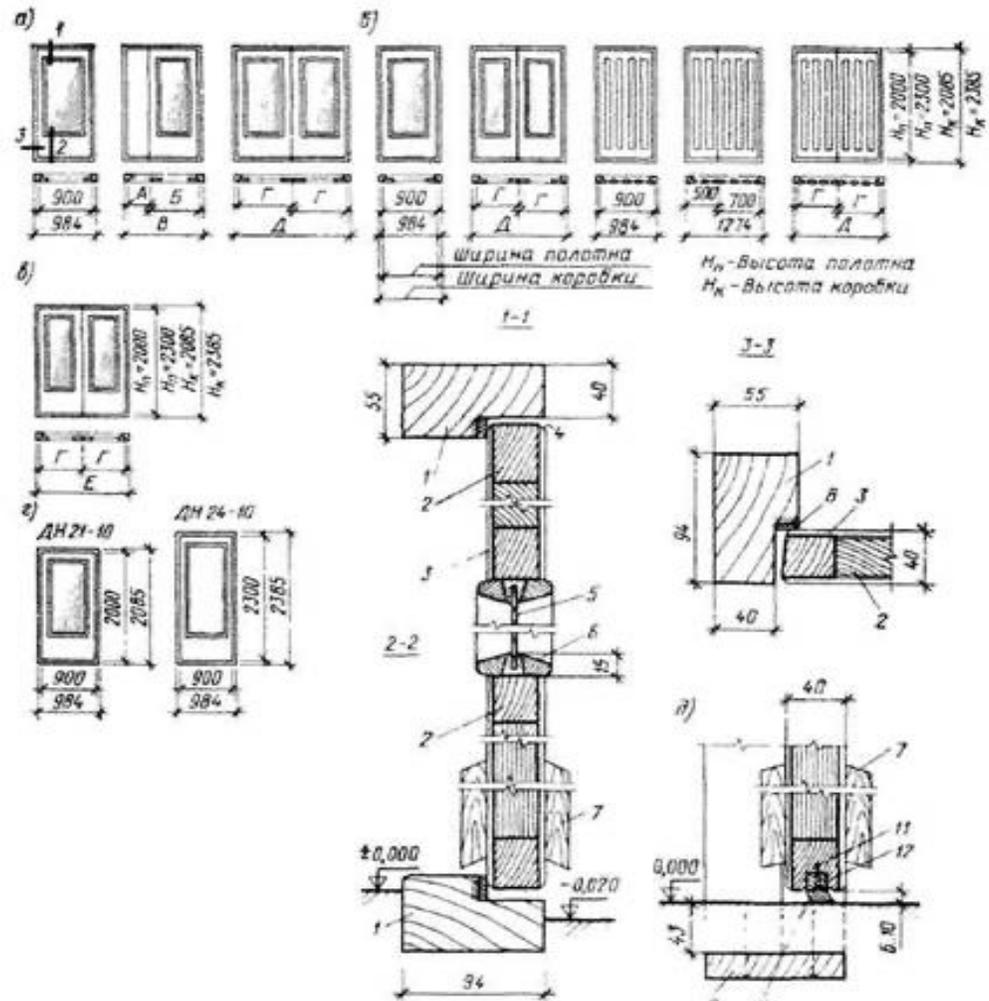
Двери деревянные наружные для жилых и общественных зданий:
